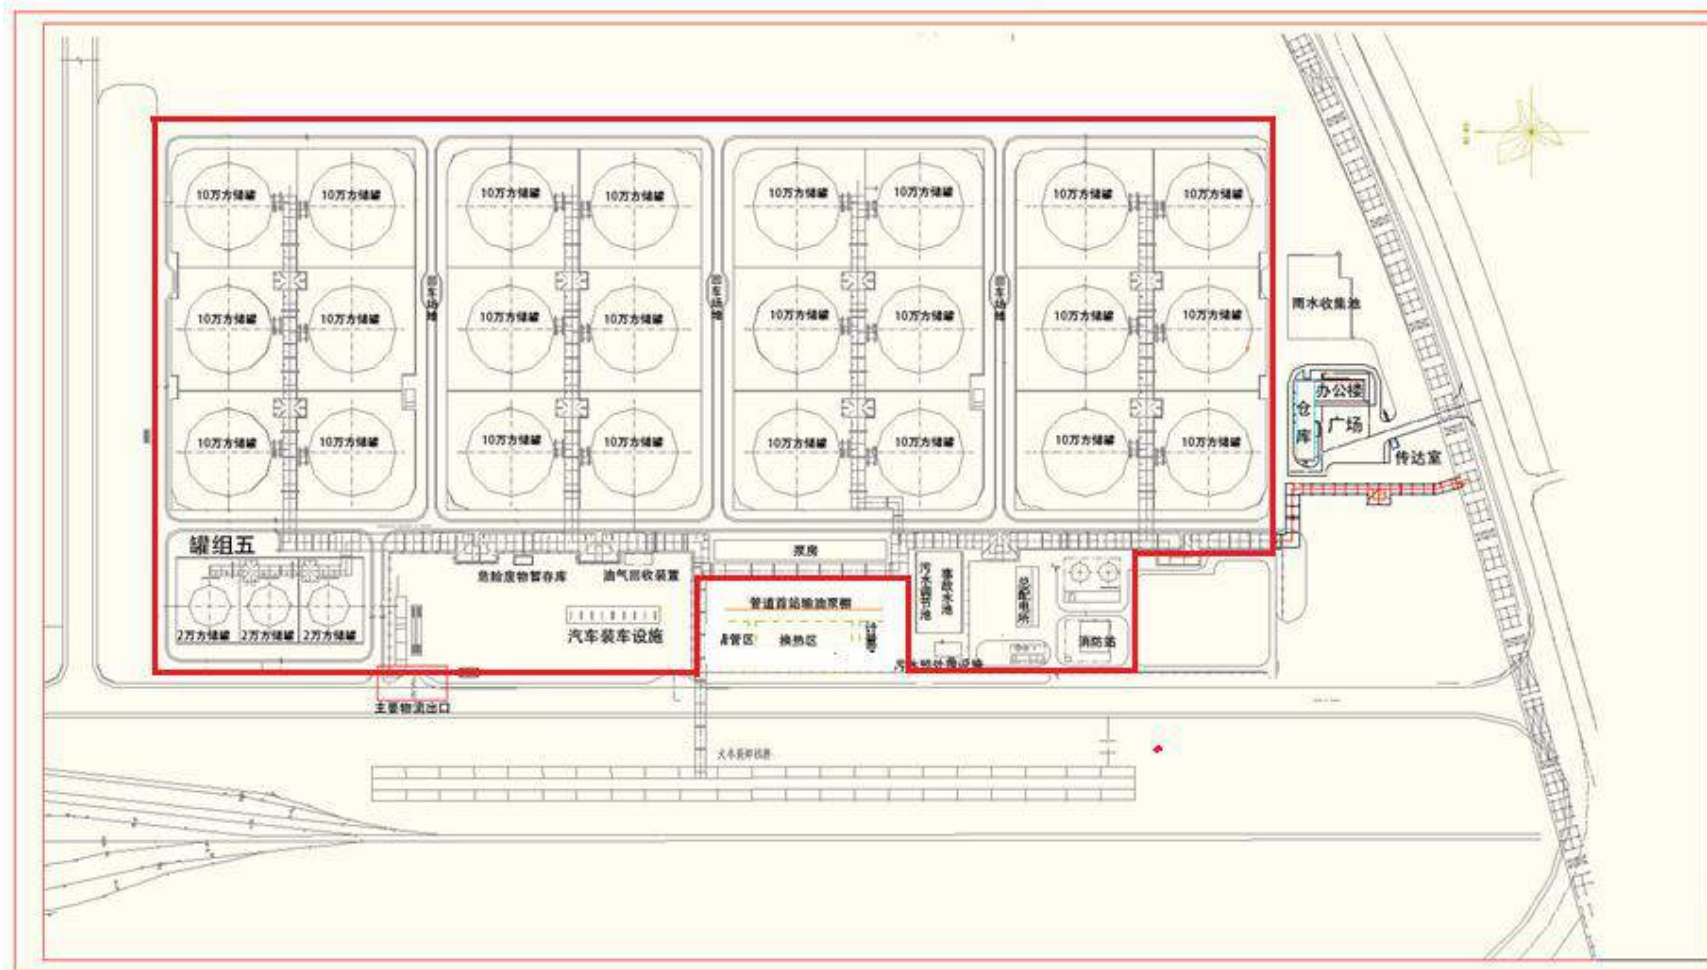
项目总平面布置图（图中红线区域为罐区范围）
